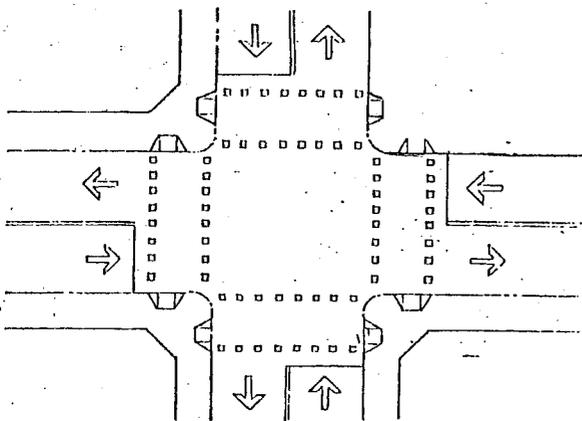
ESQUEMA DE LOCALIZAÇÃO DO REBAIXAMENTO DE GUIA EM TODA EXTENSÃO DA FAIXA DE PEDESTRES EM ESQUINAS.
